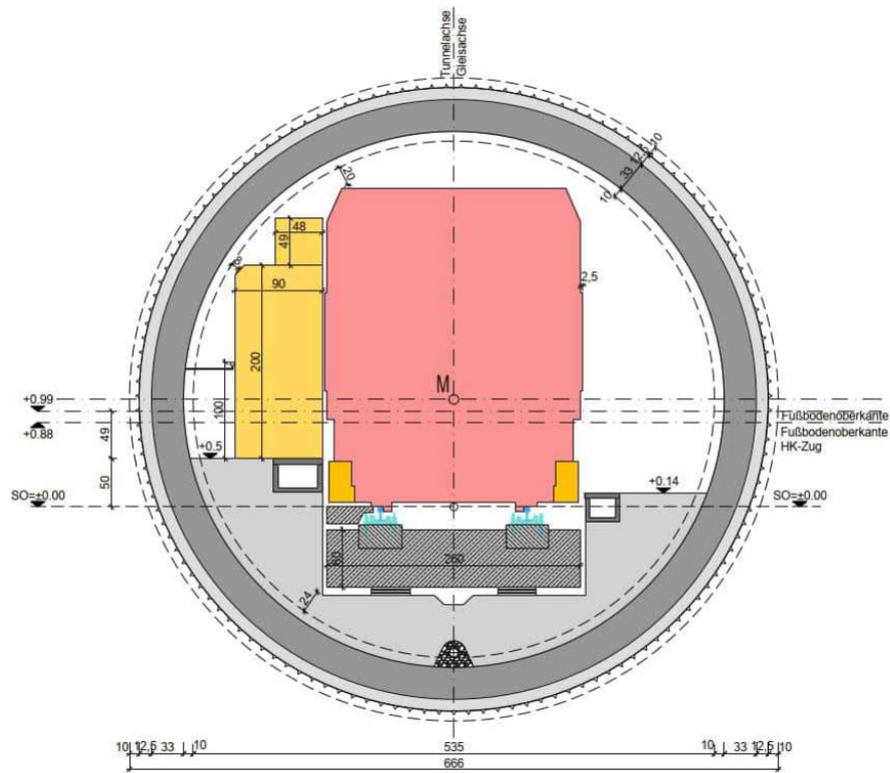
RQS Geschlossene Bauweise – Kontinuierlicher Vortrieb, mit Rettungsweg gemäß Entwurf DIN 5647
